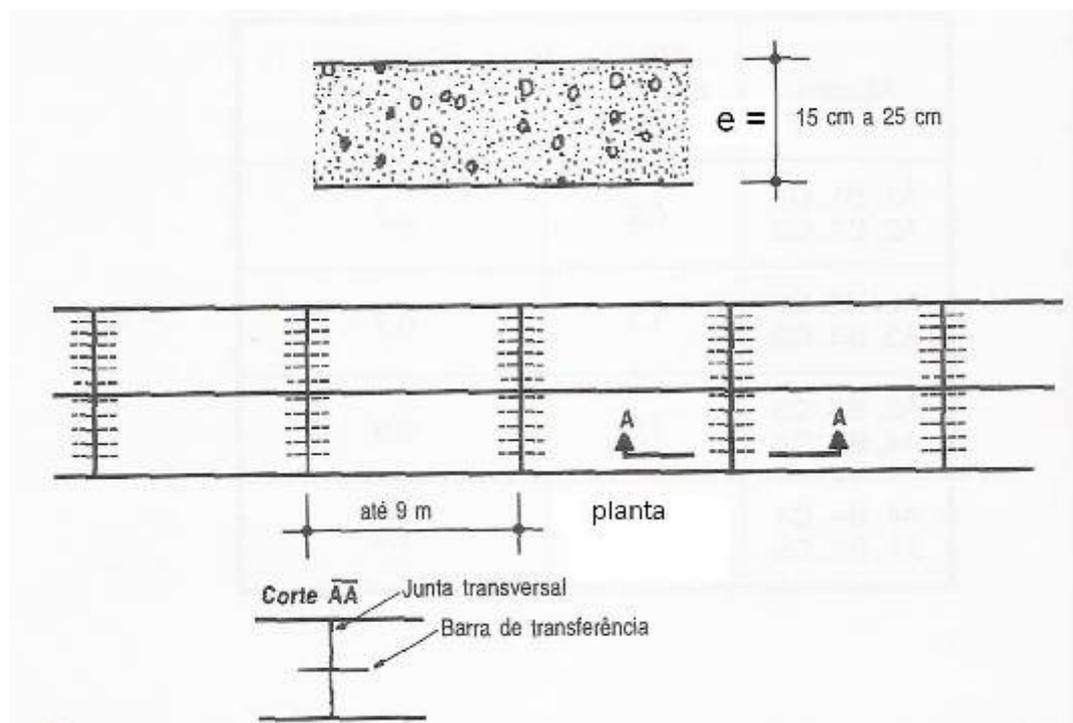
Planta e perfil típico de piso de concreto simples, onde se observam as dimensões reduzidas das placas. (Fonte Carvalho, Pitta, 1996).
